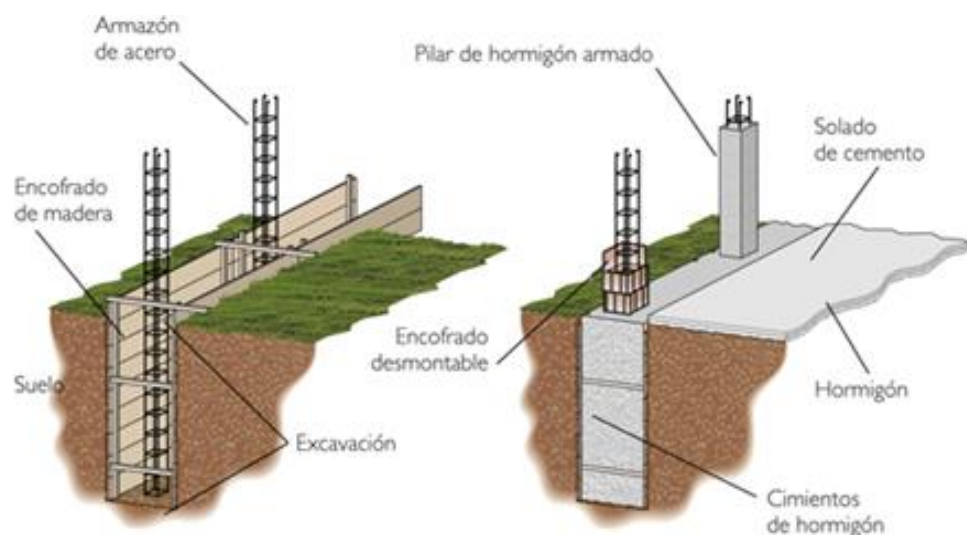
Fundaciones Aisladas de Concreto Armado (Imagen G. , s.f.)
